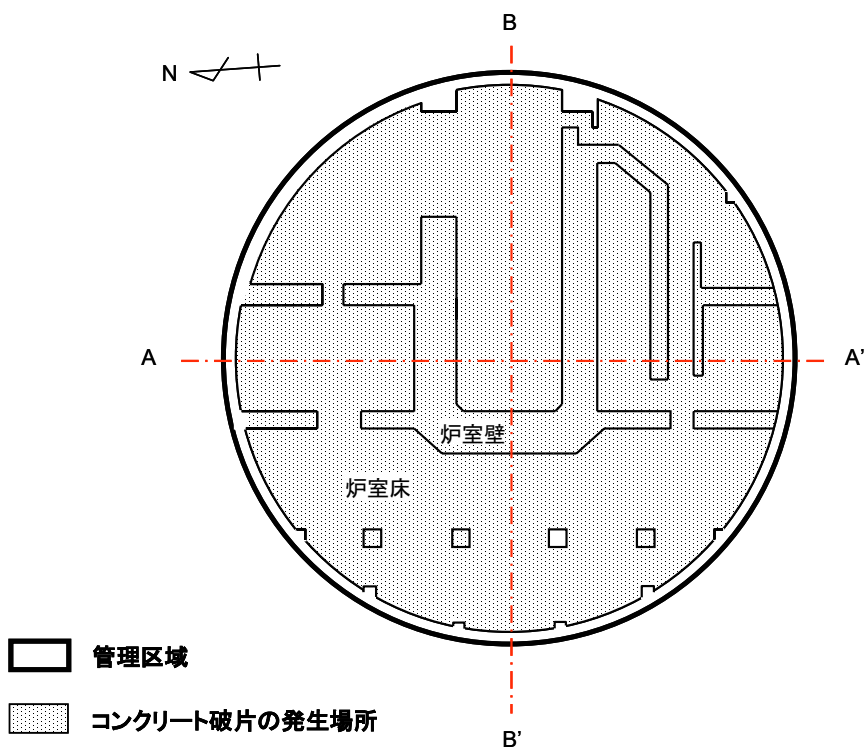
コンクリート破片の発生場所(炉室地階、D-D'平面図)
